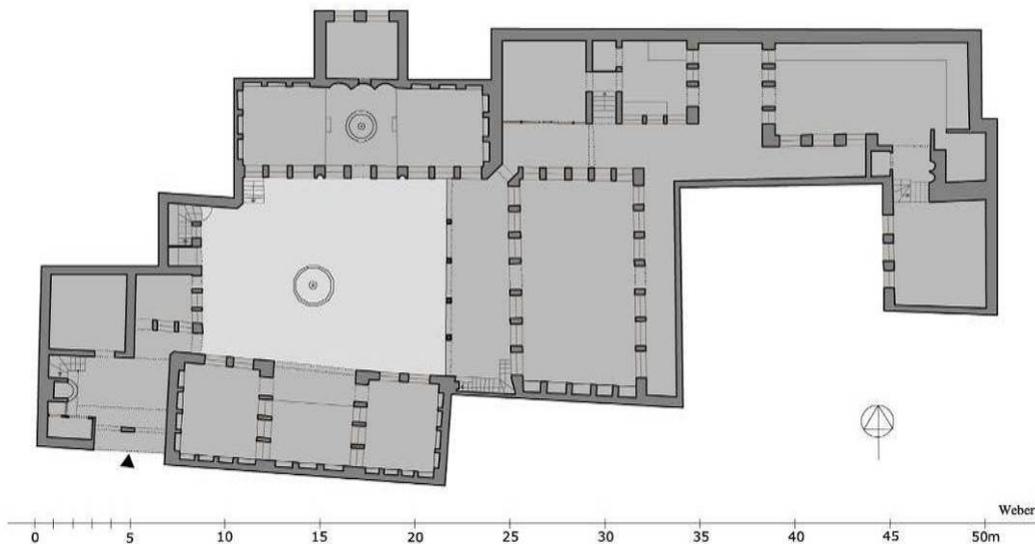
Bayt Ğabrī / al-Muğallid, Grundriss
